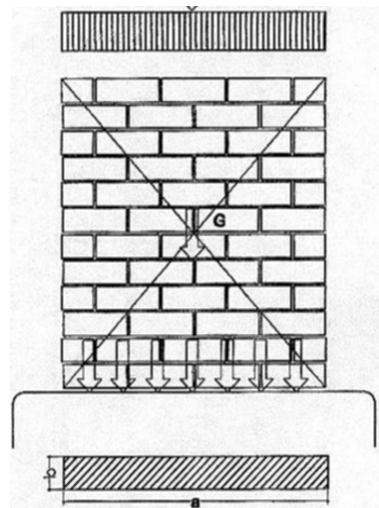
Mampostería tradicional: cargas estáticas (p+g) solicitan al muro a esfuerzos de compresión simples.
